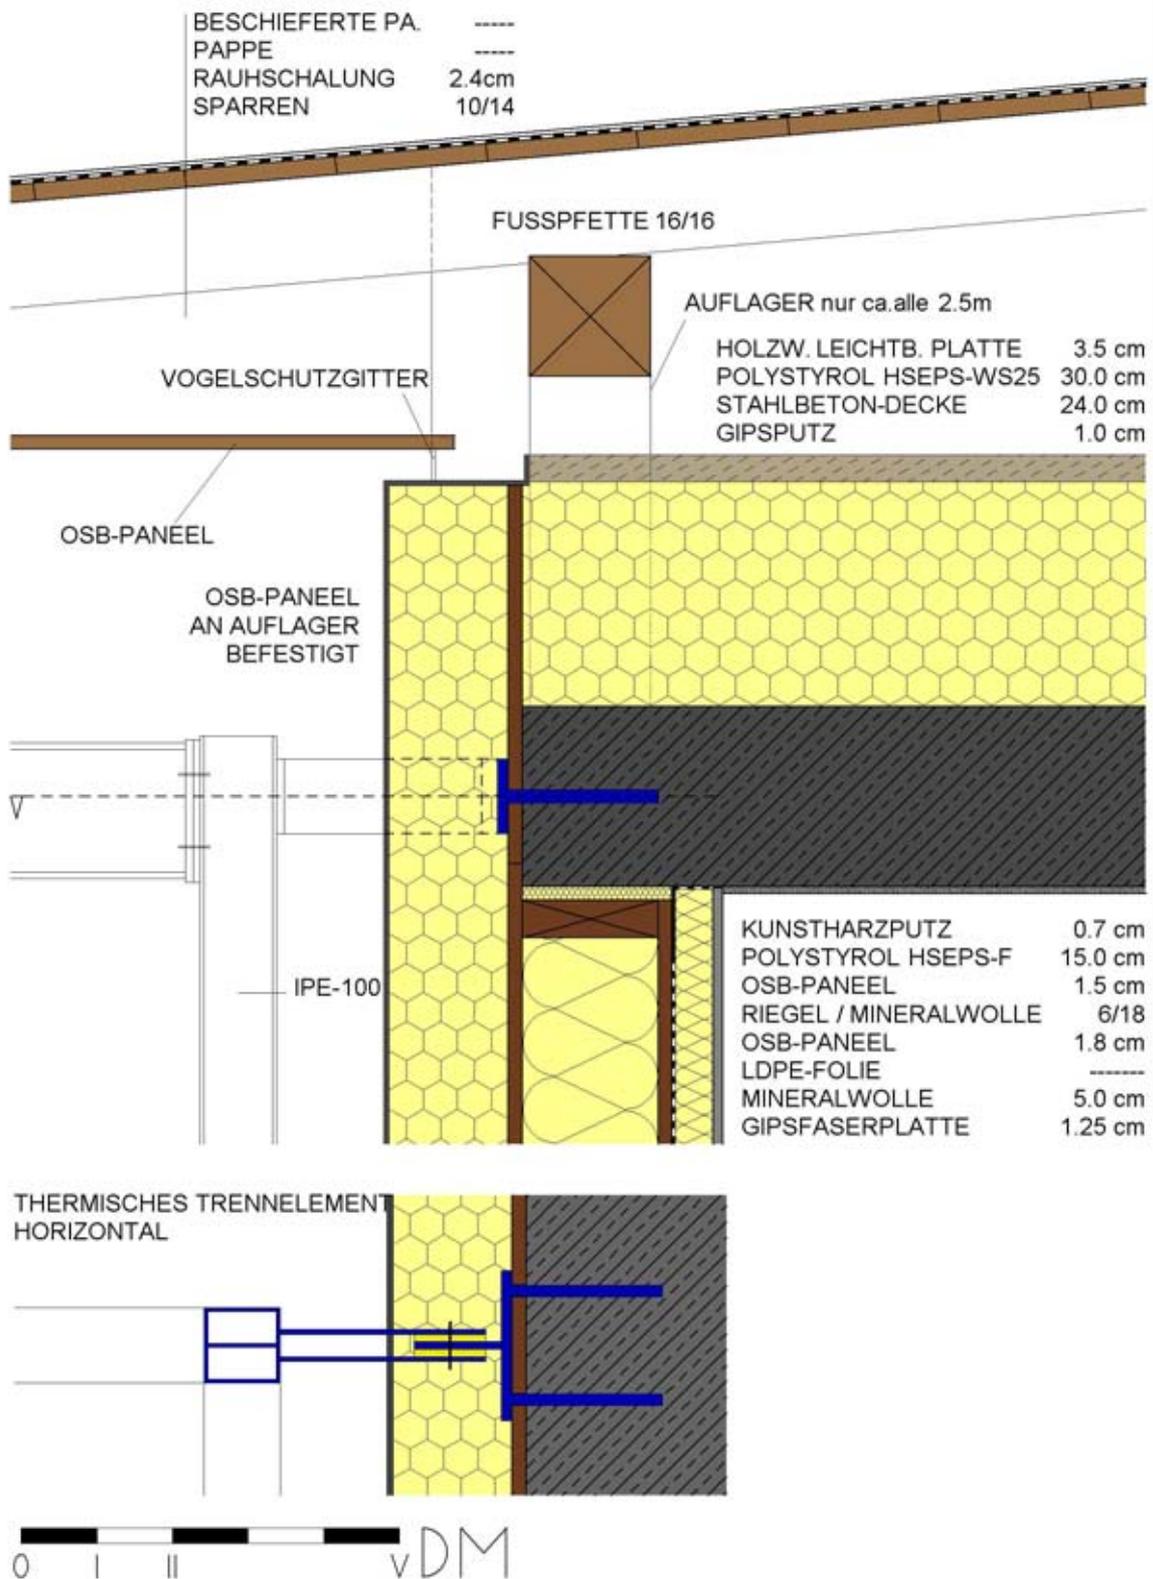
Detail Dachanschluss mit Befestigung des Terrassengerüsts
